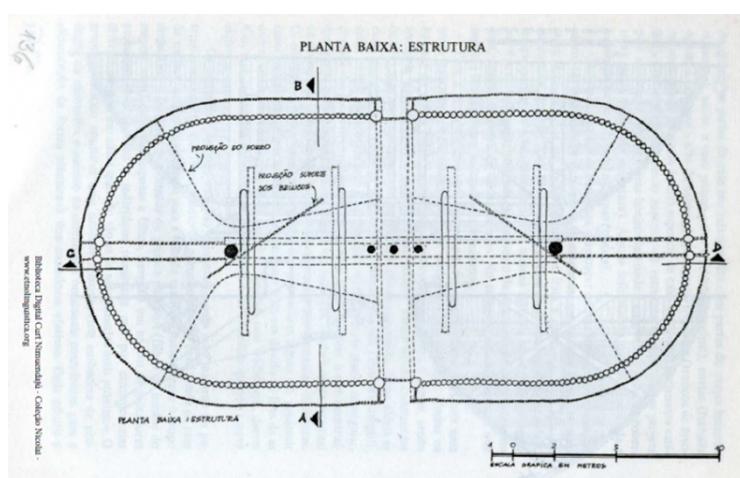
Planta baixa elipsoidal da maloca Yawalapiti
